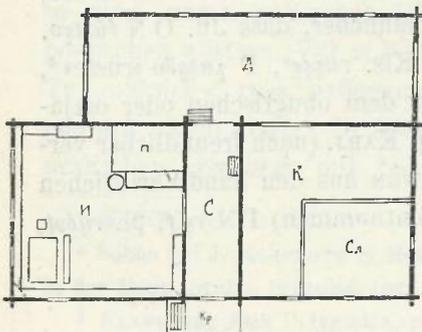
Grundriss eines tverischen gehöftes. Nach Artamonov.
